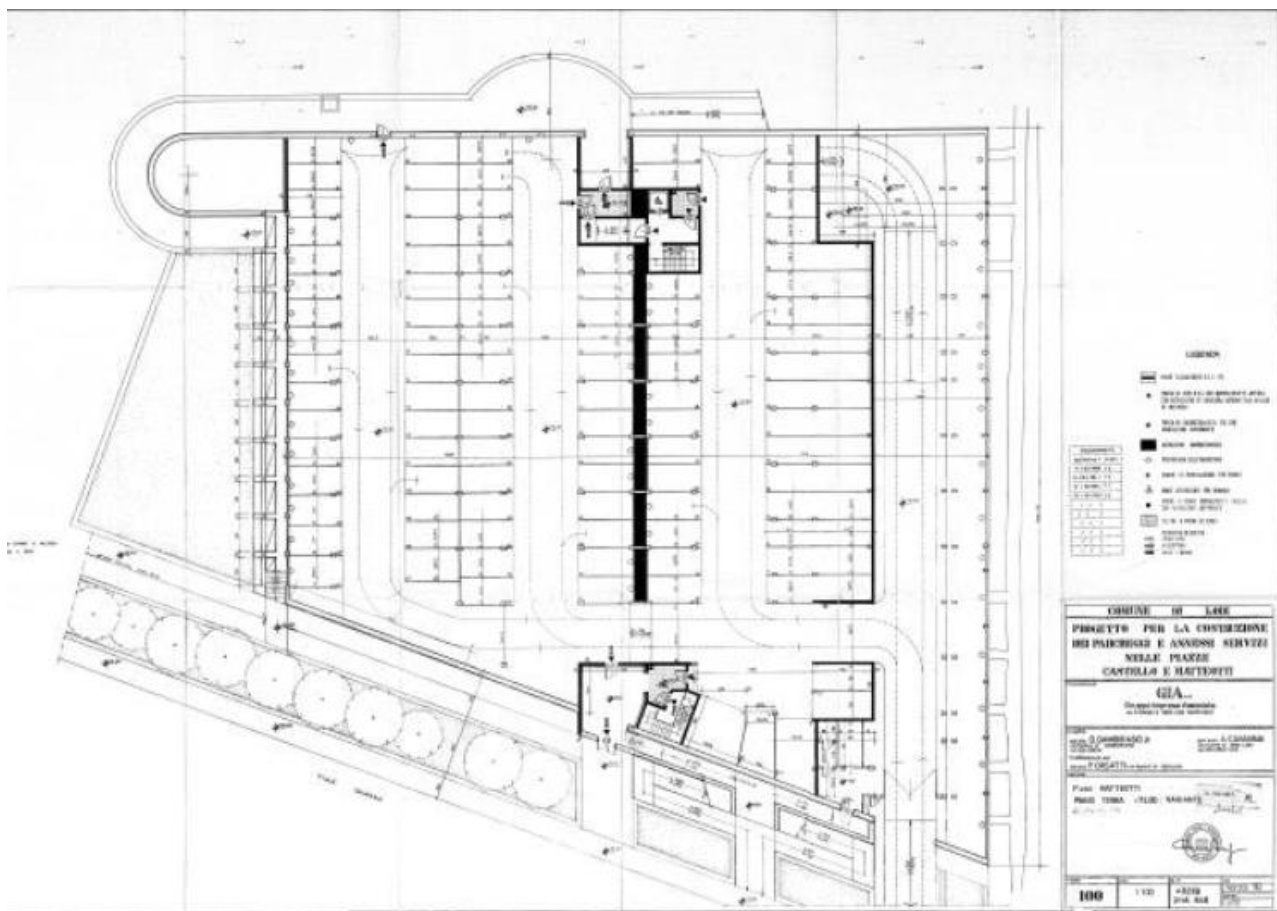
Pianta Piano terra parcheggio Piazza Matteotti
